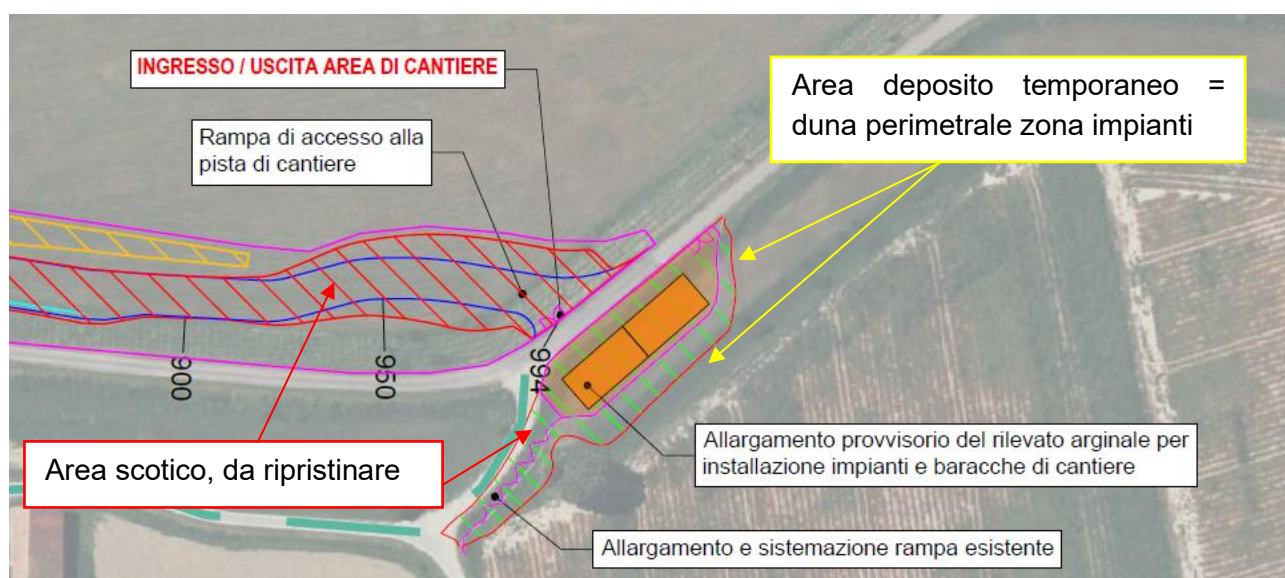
Dettaglio area installazione impianti (estratto dalla tavola PE.0.1.6.SIC.GE.P.L.0.0.1 “Layout di cantiere”)
